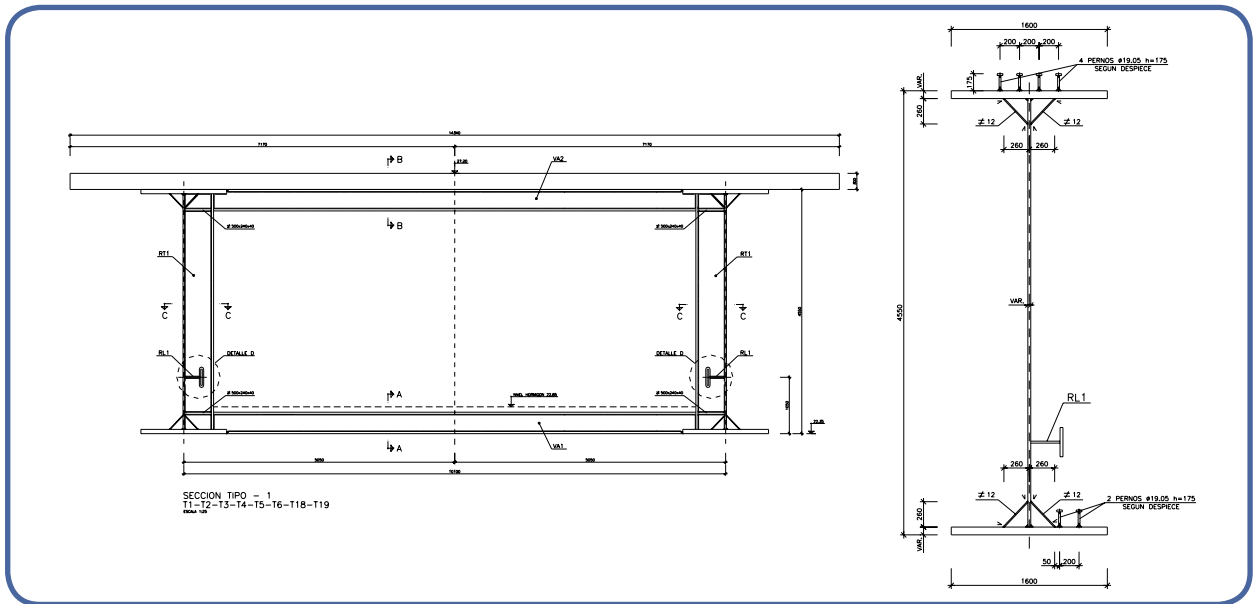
Sección transversal del conjunto viga cajón que configuran las dos vigas metálicas longitudinales y las losas superior e inferior (izquierda). A la derecha, detalle de la sección transversal tipo de las vigas superiores
